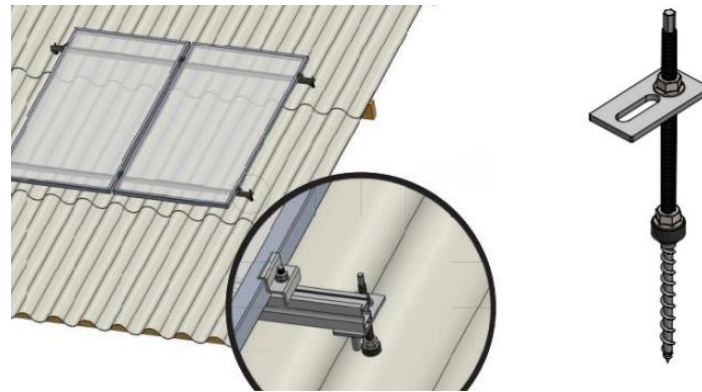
Estrutura de fixação em um telhado de fibrocimento, e detalhe no parafuso que é utilizado na fixação no telhado de madeira (Fonte: <https://gf2.ind.br/>)
